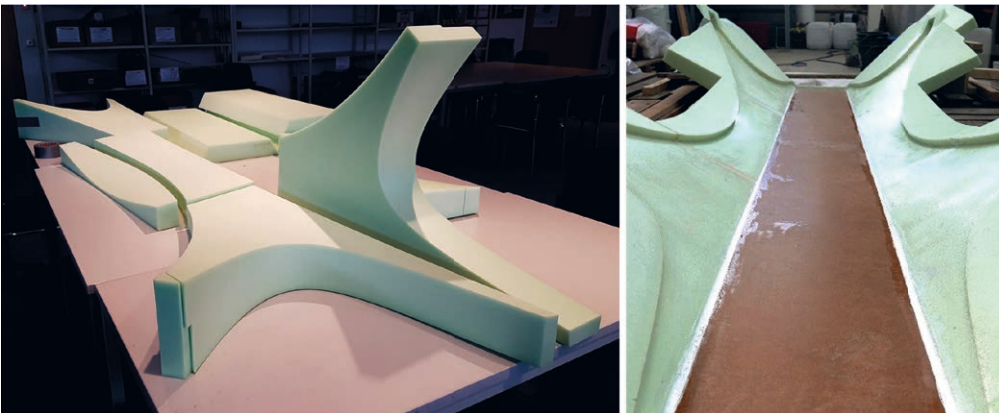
Schalungselemente und Schalung für den Demonstrator | Fig. 9: Formwork for the shell bridge
